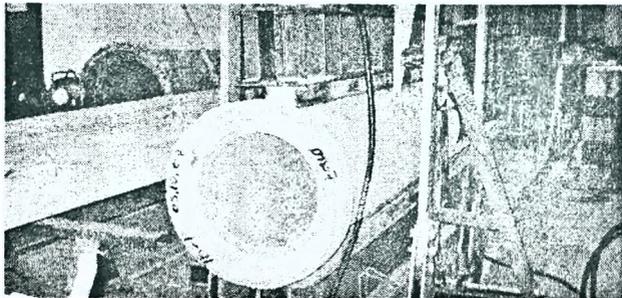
Испытание бетонной трубы марки БТ30.25-2
